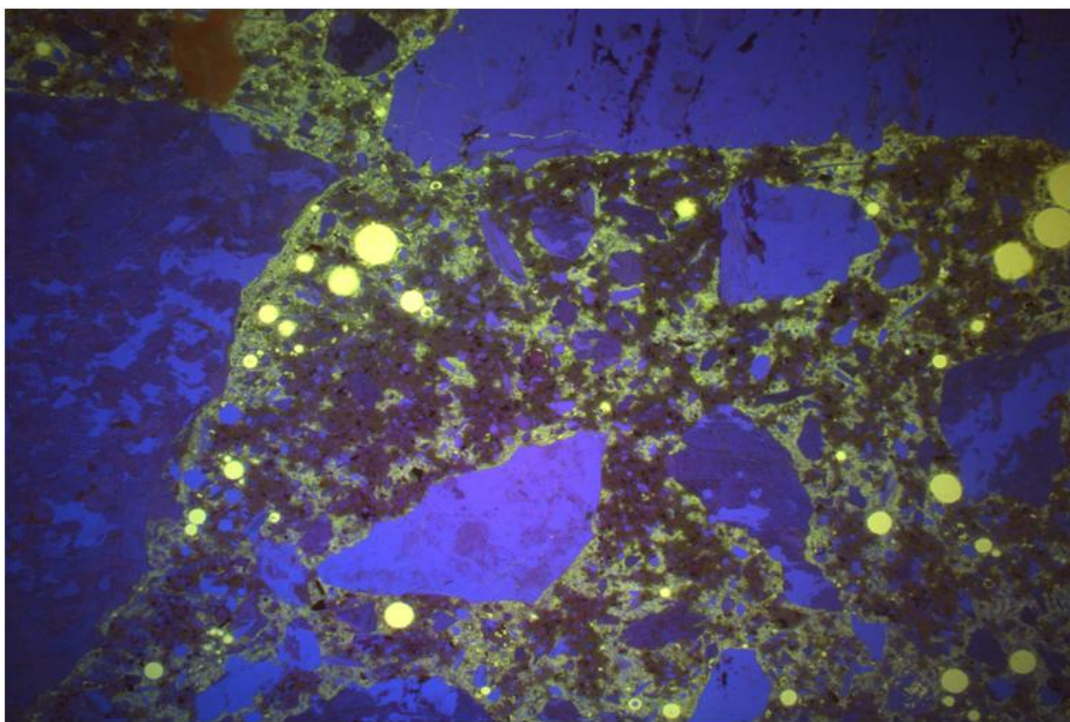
Prov K2, från Överumans regleringsdamm. Planslip belyst med UV ljus. Planslipets längd är 210 mm. Betongens yta finns till vänster i bilden.
